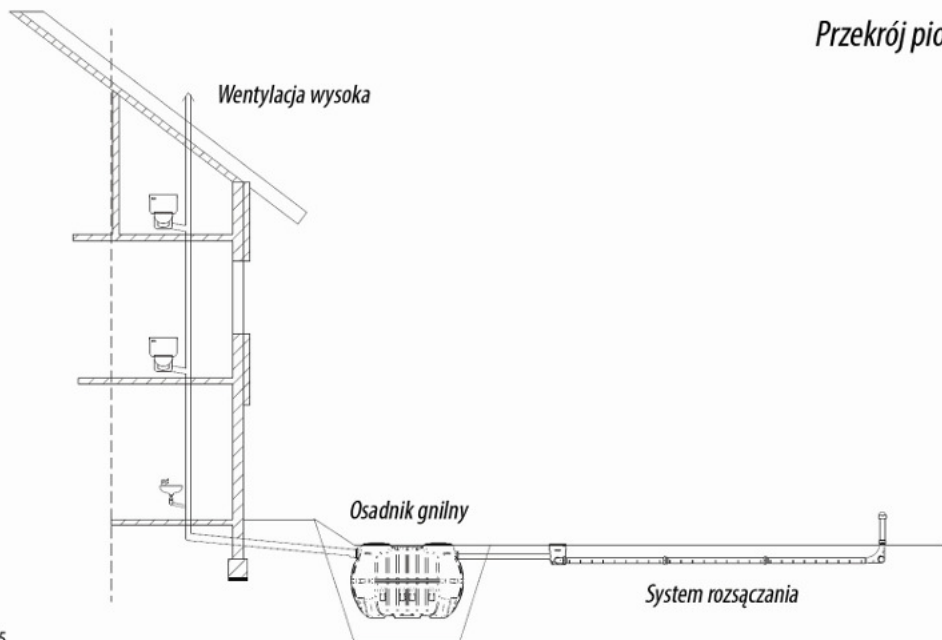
Przykład instalacji zbiornika BOLT 2,5 z tunelami rozsączającymi
